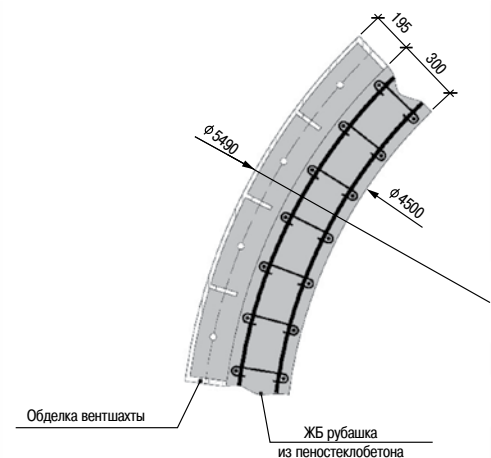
Конструкция железобетонной рубашки из пеностеклобетона
